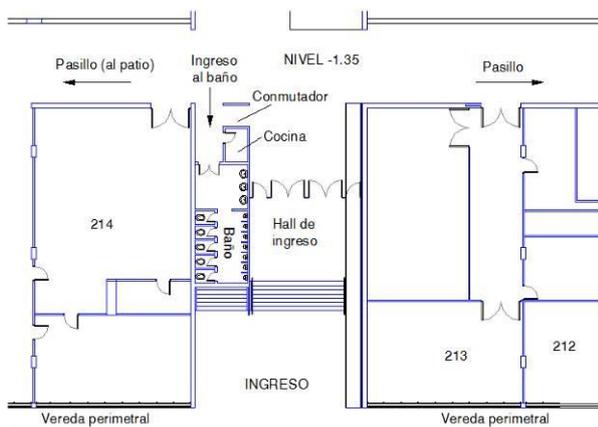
Plano 2 Nivel – 1.35 Plano Baño 1
